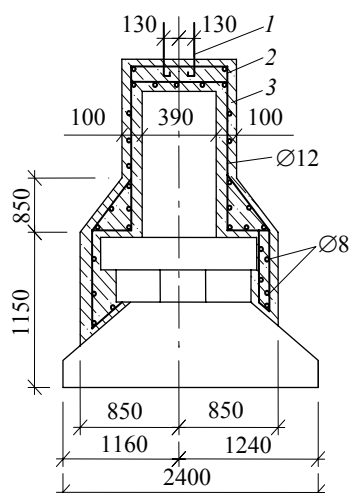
Вариант усиления железобетонной облоймой сборного отдельного фундамента:
